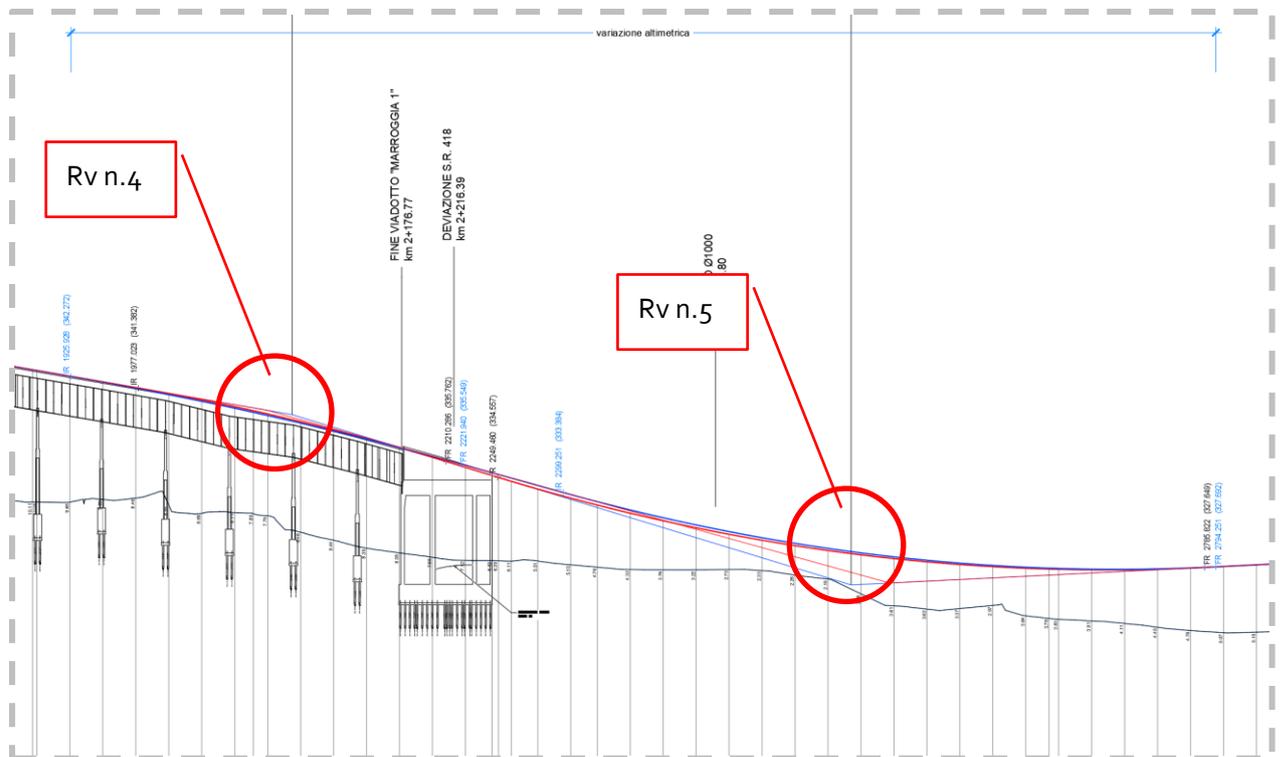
Sovrapposizione profilo longitudinale PD2021 e PE
